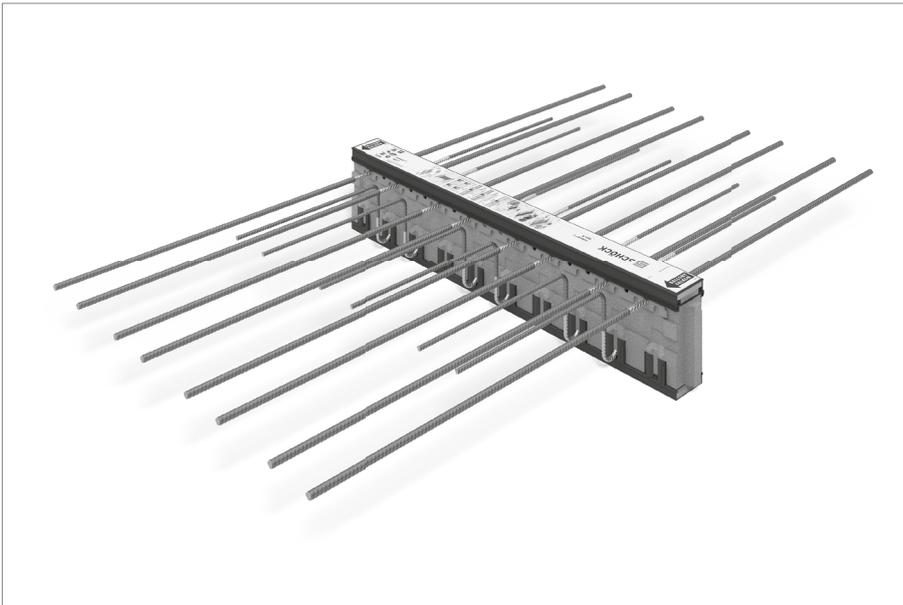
Schöck Isokorb® T Typ KL in Brandschutzausführung
